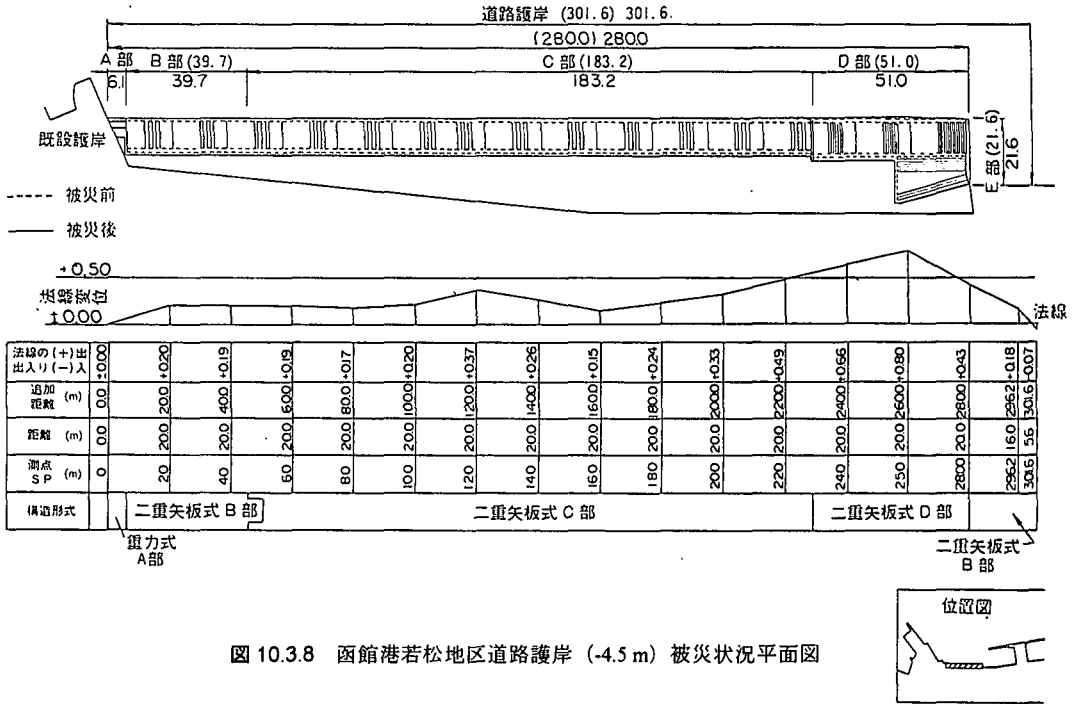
函館港若松地区道路護岸 (-4.5m) 被災状況平面図
